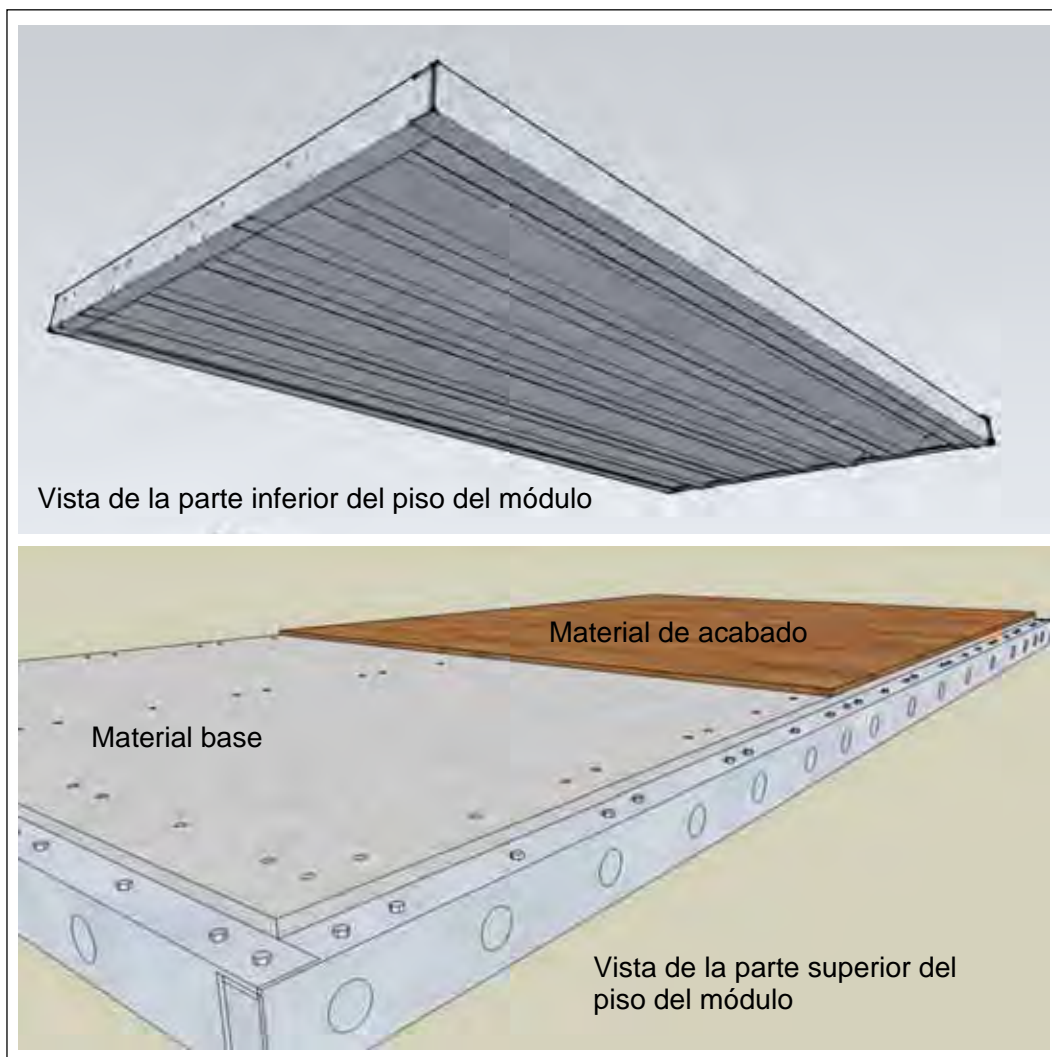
Armado de la losa de piso. Fuente: Elaboración propia. 2008
